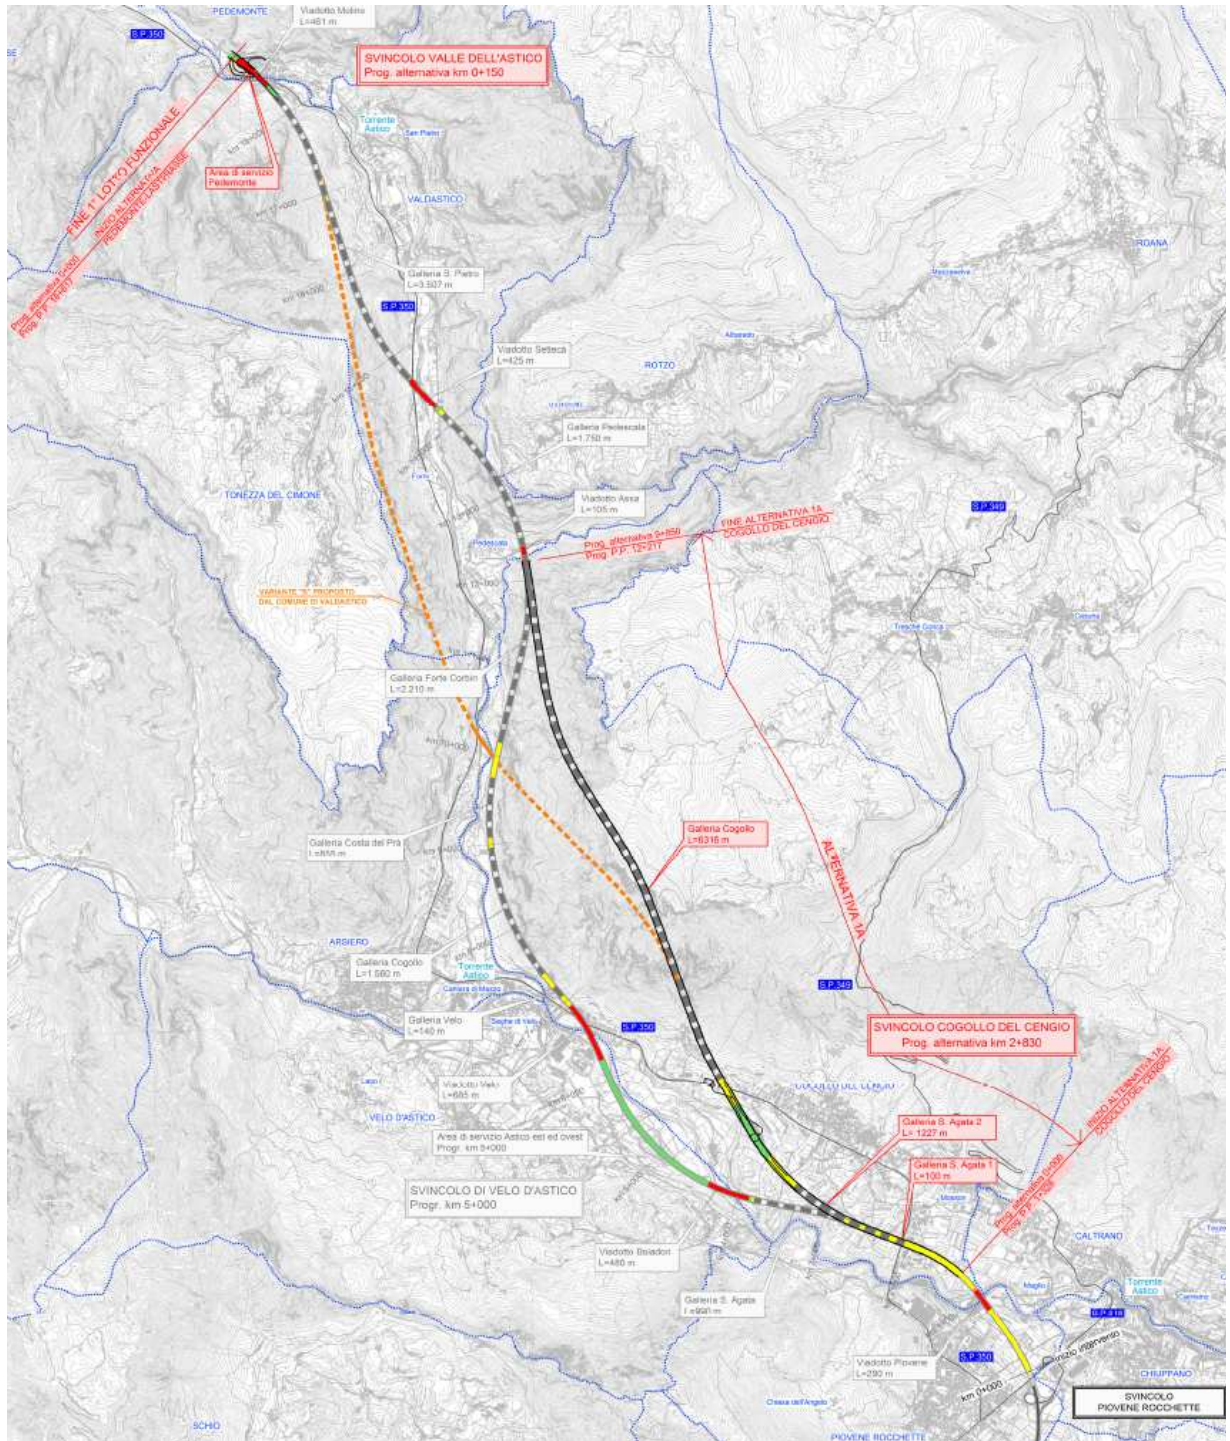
Planimetria schematica della Variante "B" (in arancione)
